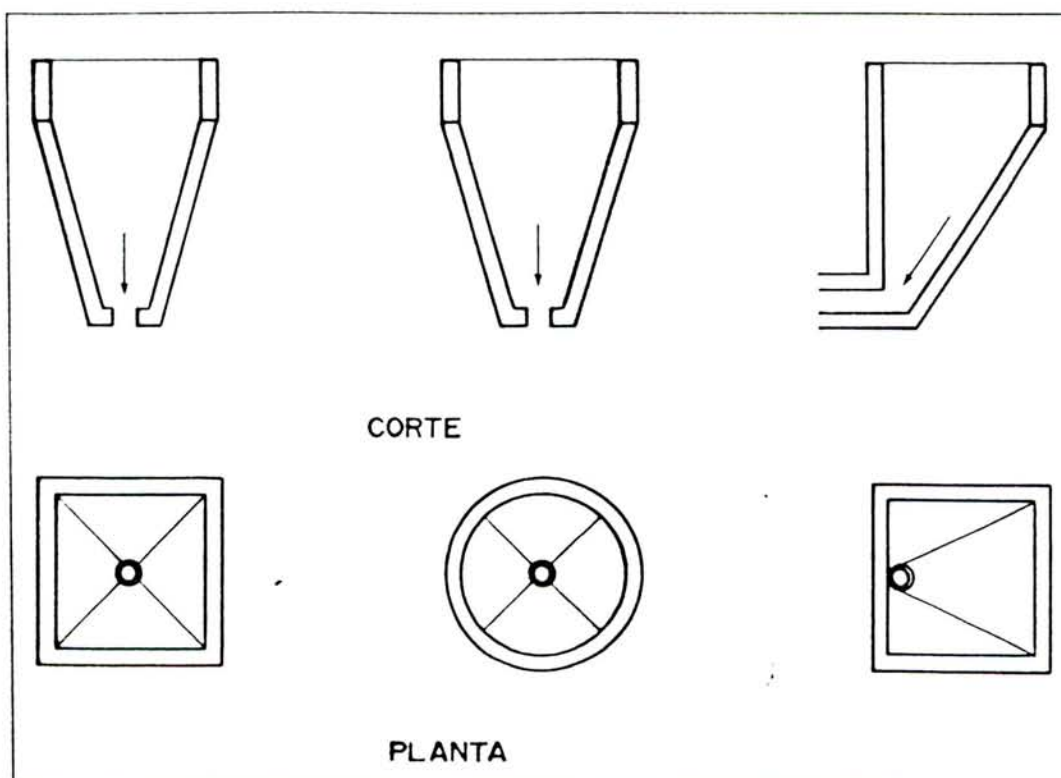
Tipos de Fondos en Tanques Sifón. Corte y Planta.
